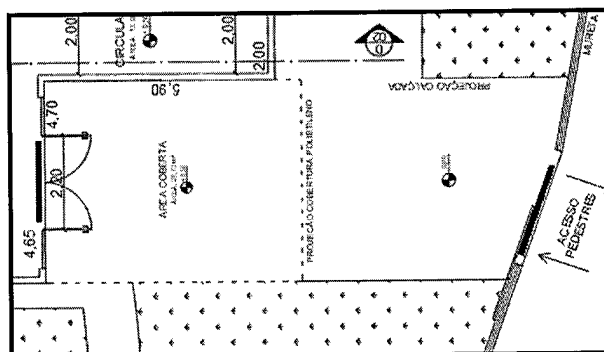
Piso em concreto existente a ser revestido com pedra são tomé
